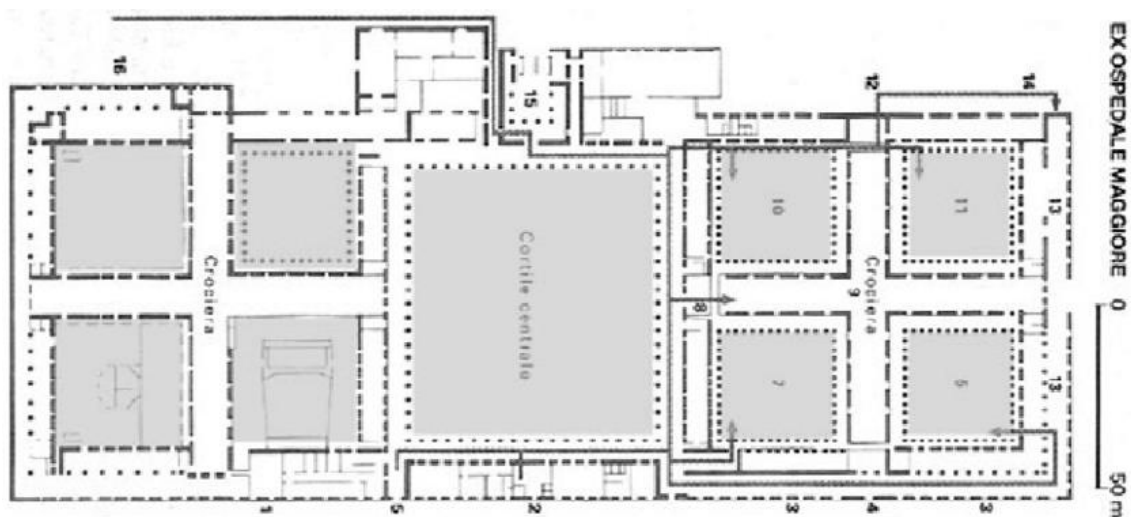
Plano do Ospedale Maggiore Fonte-Adaptado de (Arounder 2009)
